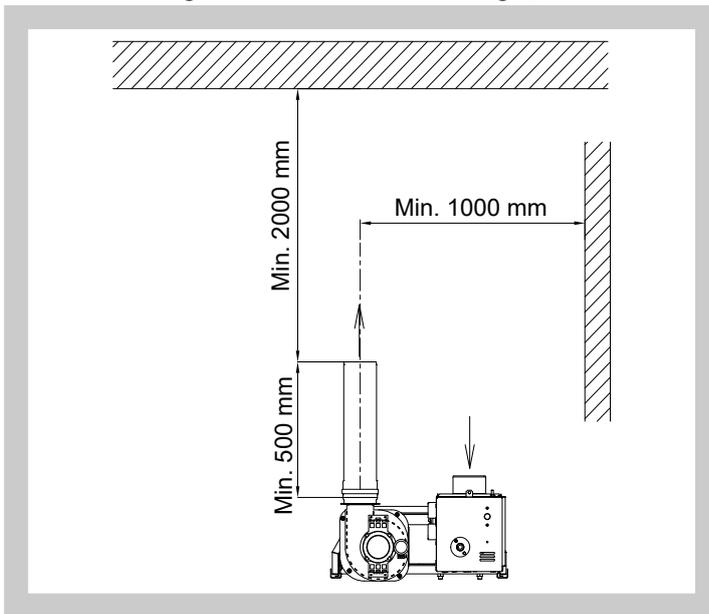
Abgasleitung und Verbrennungsluftzufuhr durch getrennte Rohrleitungen – Dachausführung
